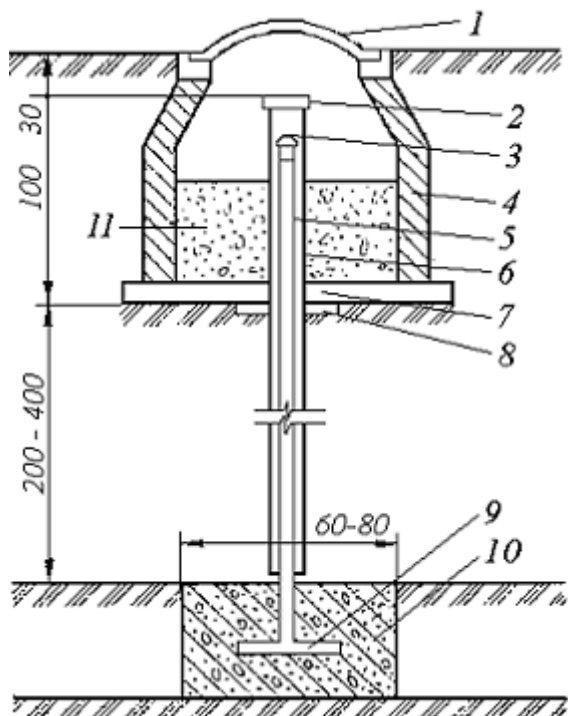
Трубчатый грунтовой репер на бетонном фундаменте:
